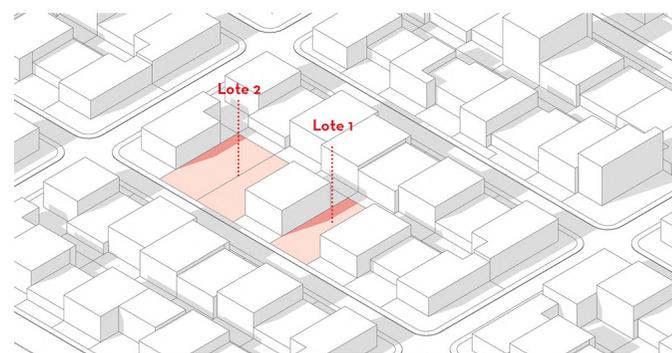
Isometría de Lote tipo 1 y Lote tipo 2
